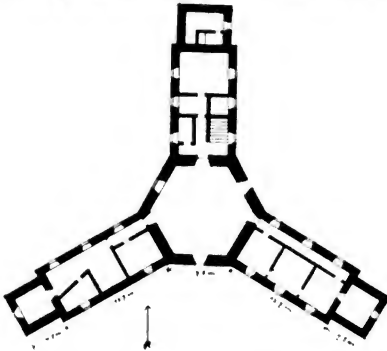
Černitz. Grundriss des Jagdschlusses.
